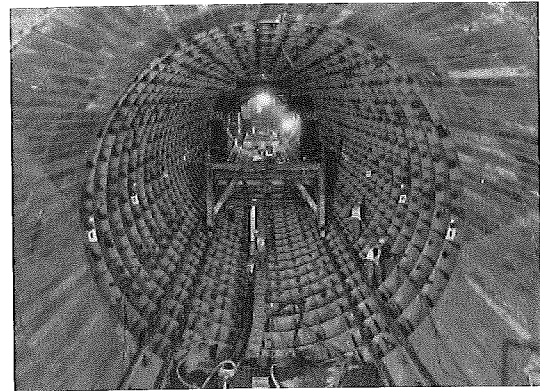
南エントランストンネル斜坑鋼製セグメント覆工施工状況
